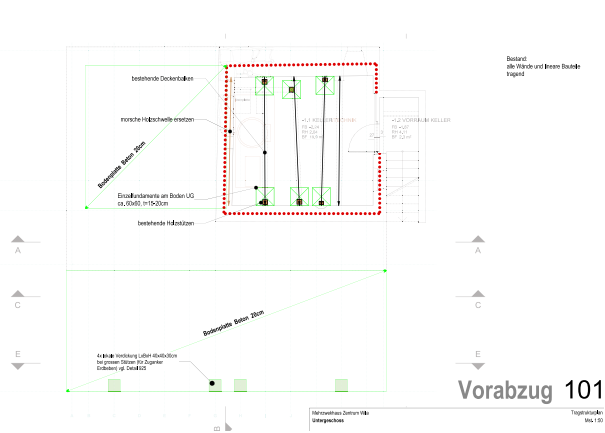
Grundriss UG Bauingenieur Konzept
